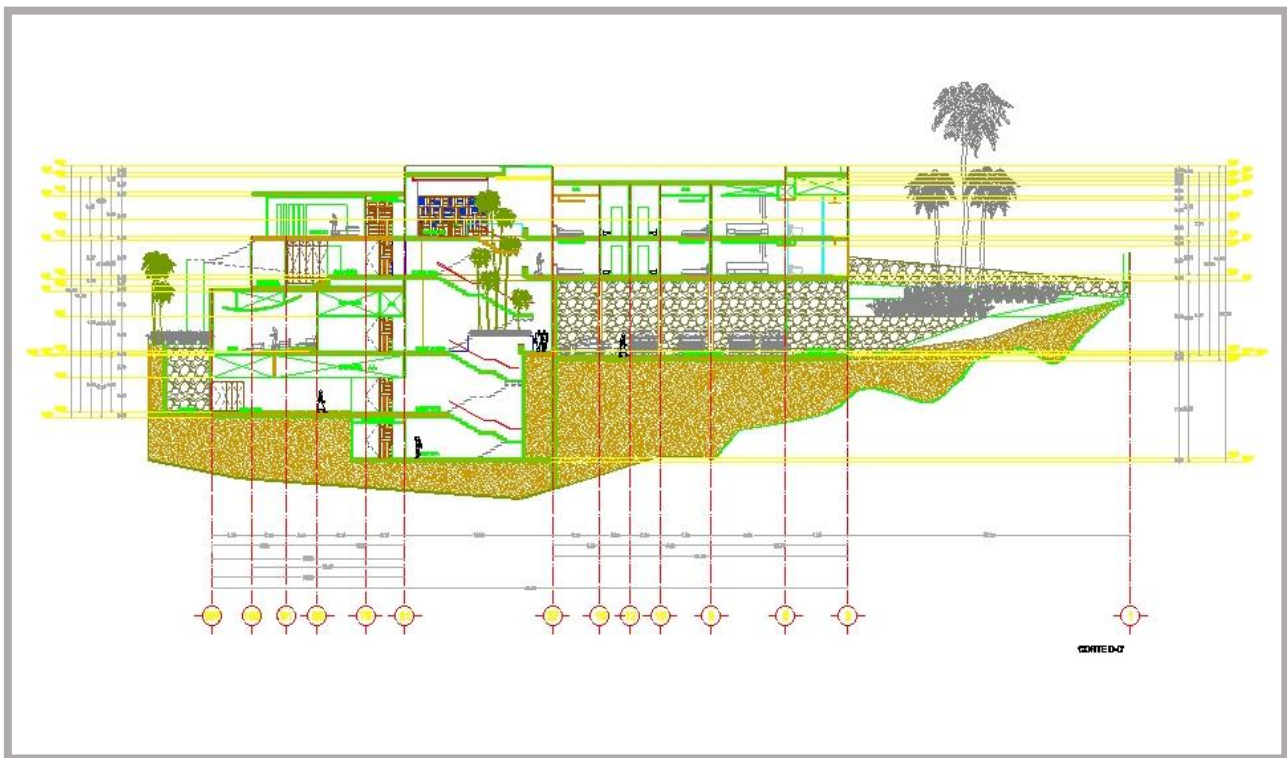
Plano arquitectónico C, perfil vertical de la obra
